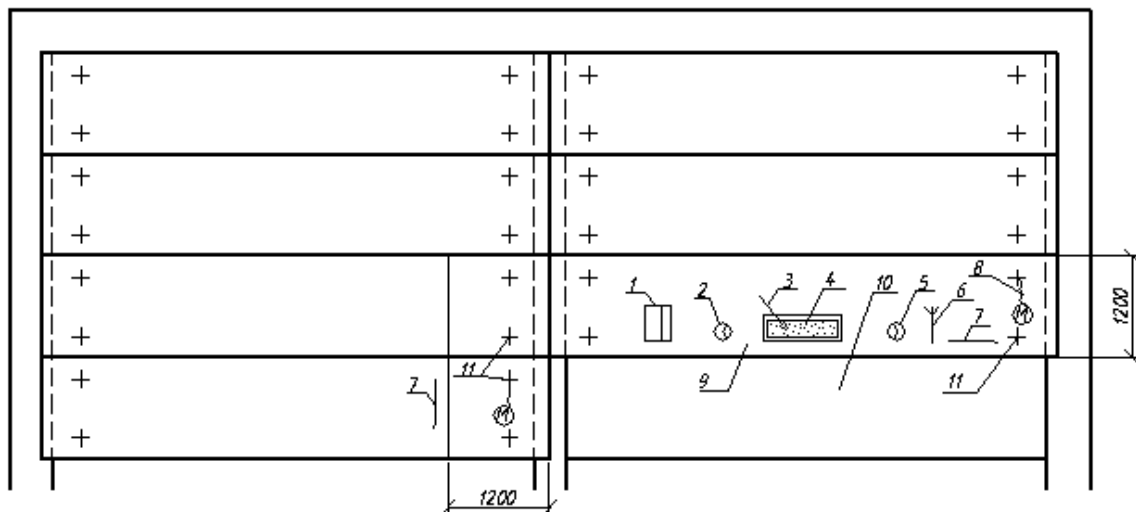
Схема организации рабочего места монтажника при монтаже плит перекрытия. 1 — ящик с инструментом; 2 — ведро для воды; 3 — лопата; 4 — ящик для раствора; 5 — ведро для раствора; 6 — метла; 7 — лом монтажный; 8 — пояс предохранительный; 9 — смонтированная плита; 10 — место установки монтируемой плиты перекрытия; 11 — петли строповочные; — рабочее место монтажника
